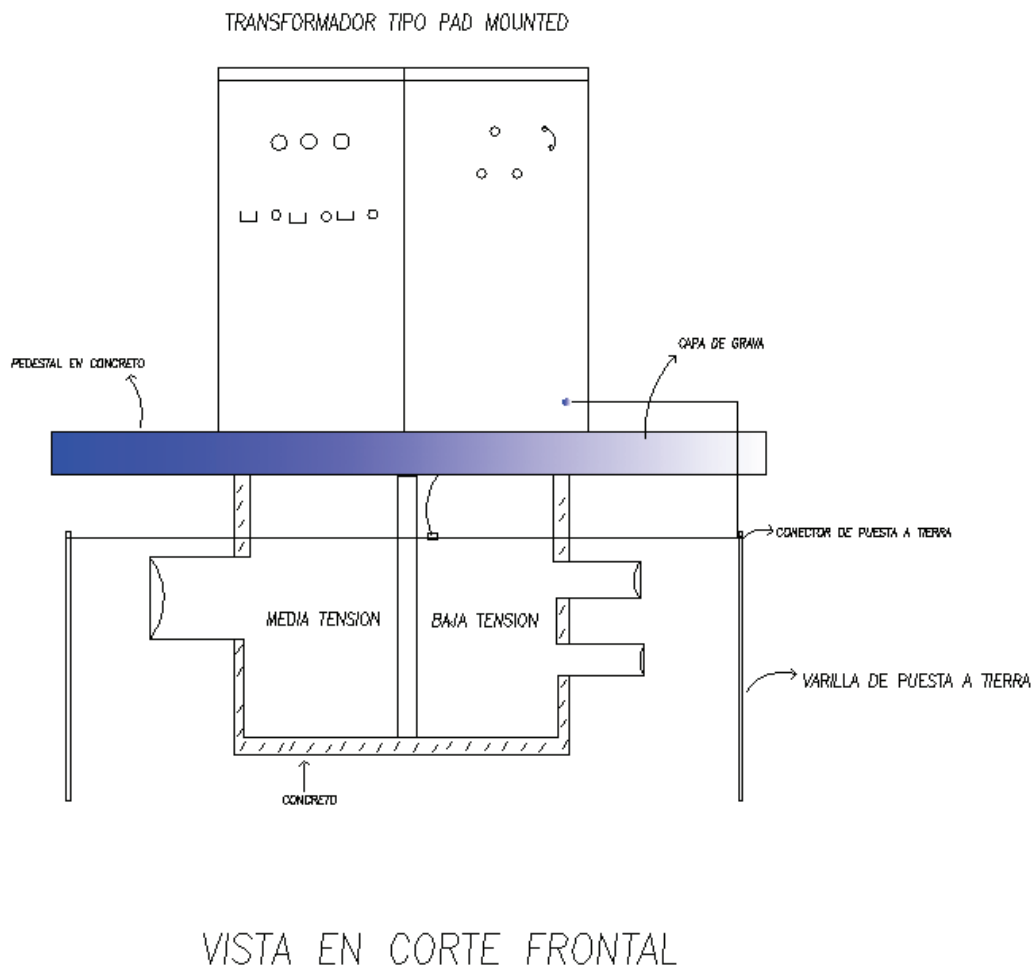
Transformador Tipo PAD MOUNTED vista Frontal
